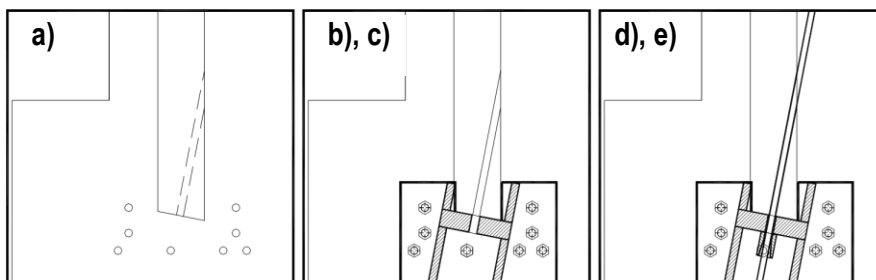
Ancoragem inferior - Fases de montagem e aplicação do pré-esforço
